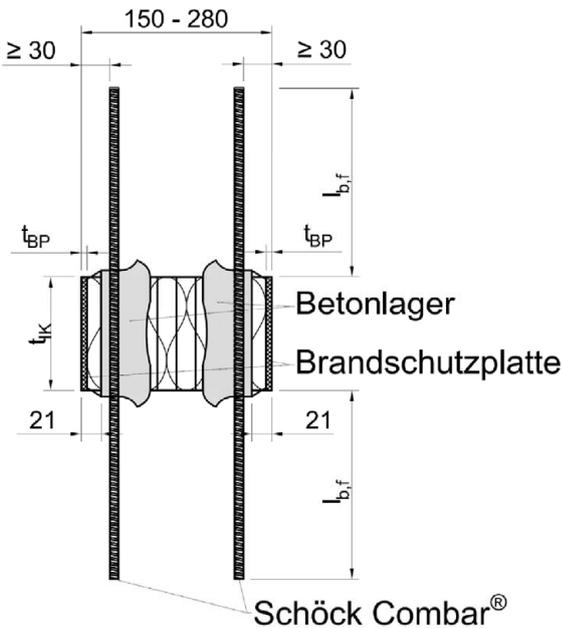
Schöck Isokorb® CXT Typ A für Attiken und Brüstungen
